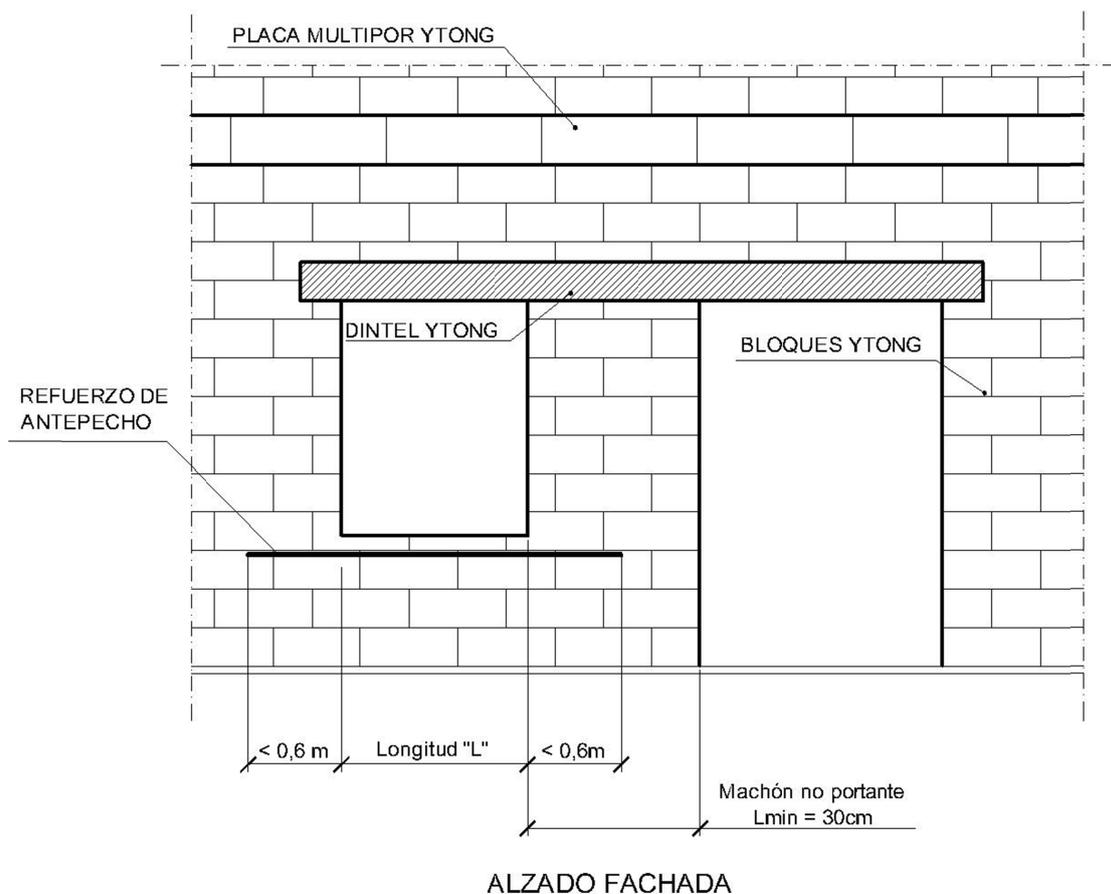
Detalle alzado fachada con bloques Ytong
